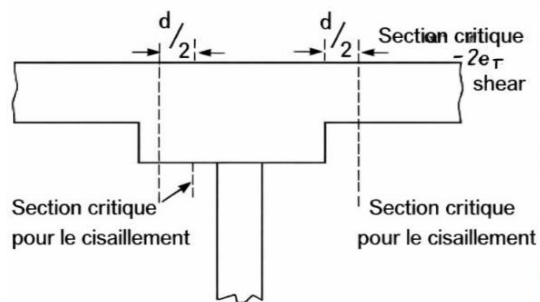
Dalle pleine sans tête et avec retombée de panneau [13]
